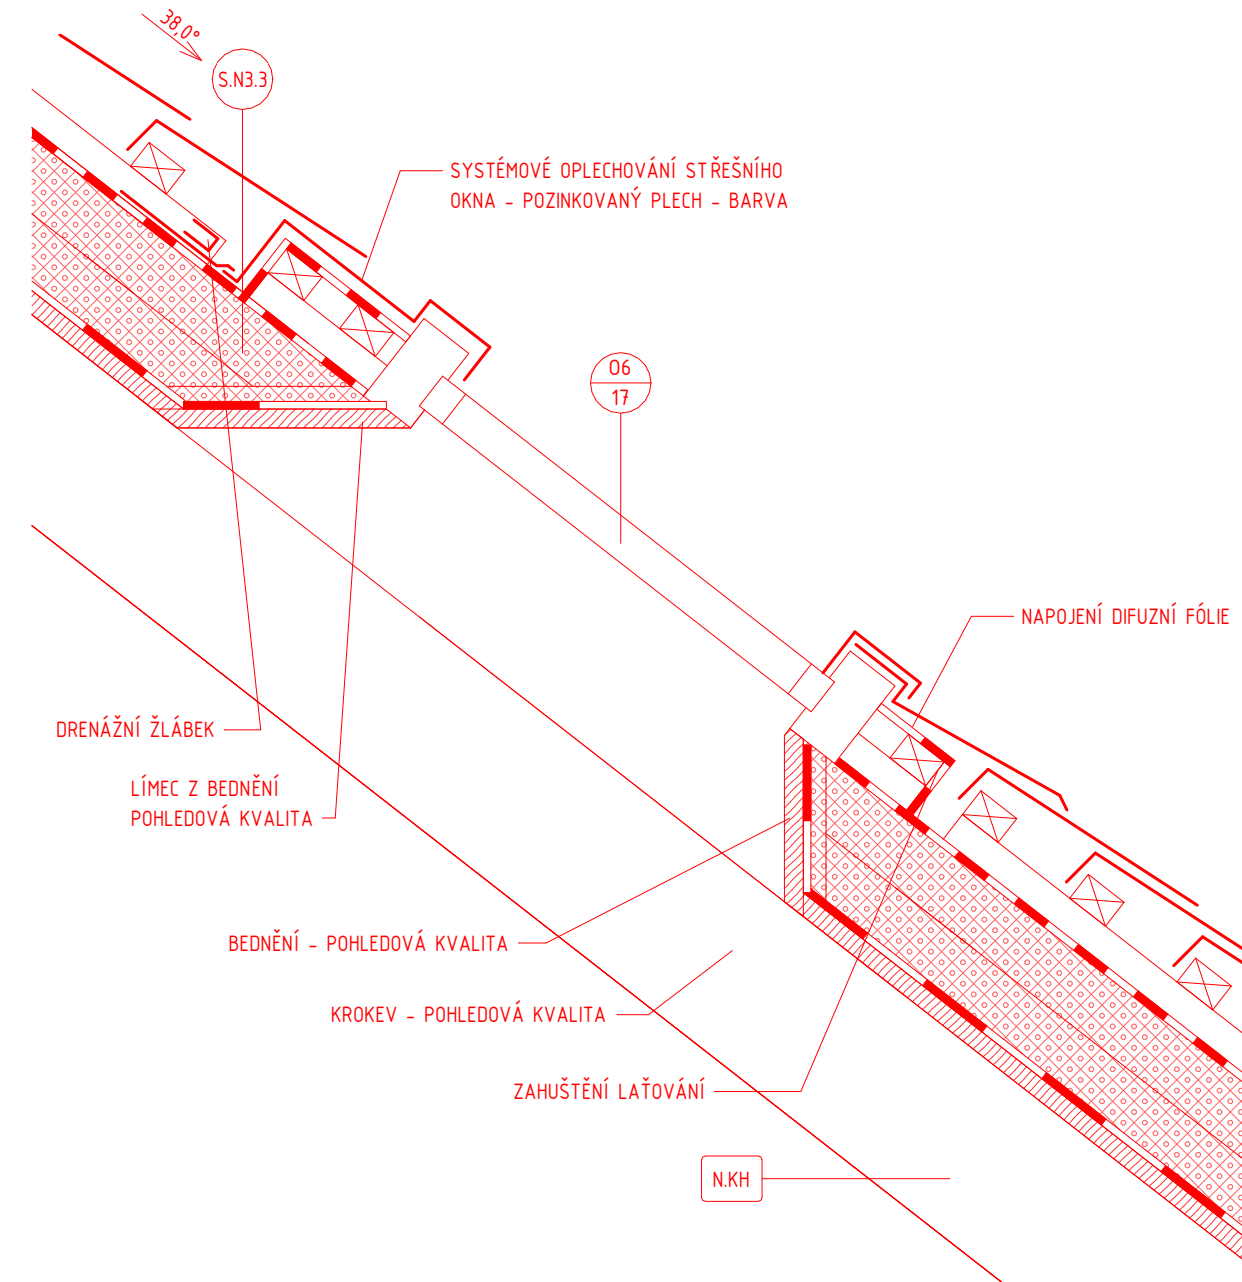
DETAIL L - PULTOVÁ STŘECHA U ŠTÍTU
